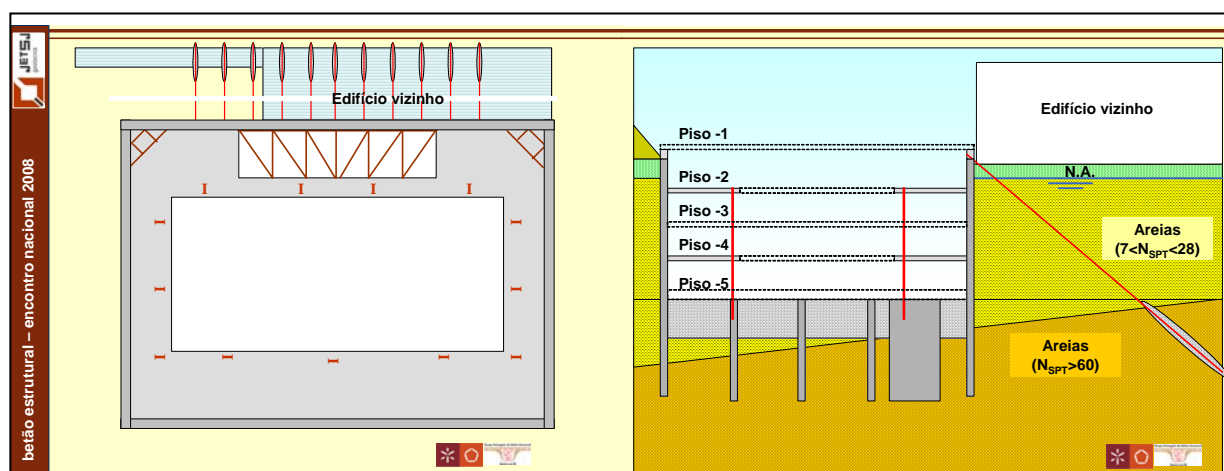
Planta e secção transversal tipo da solução de travamento da contenção periférica aceita.
